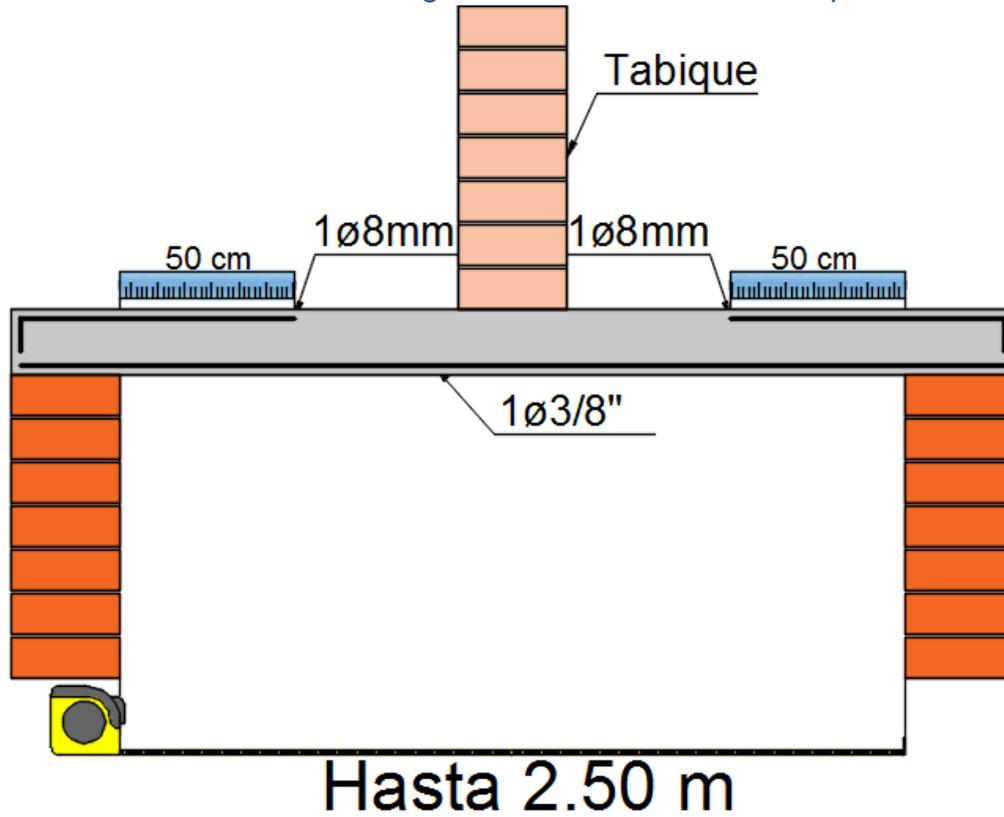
Refuerzo de vigueta hasta 2.50 m con tabique encima.
